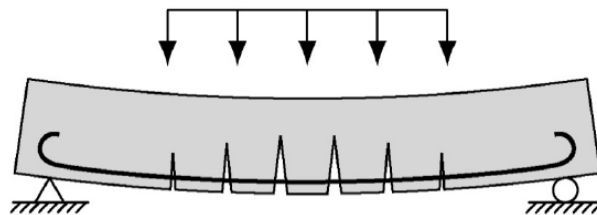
Viga de concreto reforzado bajo cargas *Fuente:* [3].
